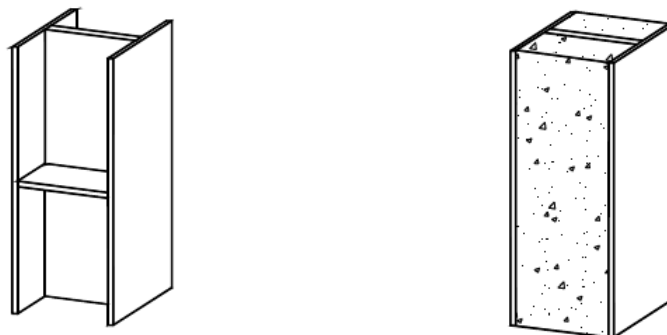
Rigidificadores de alma do pilar com chapa soldada e revestimento de betão respectivamente [27]
